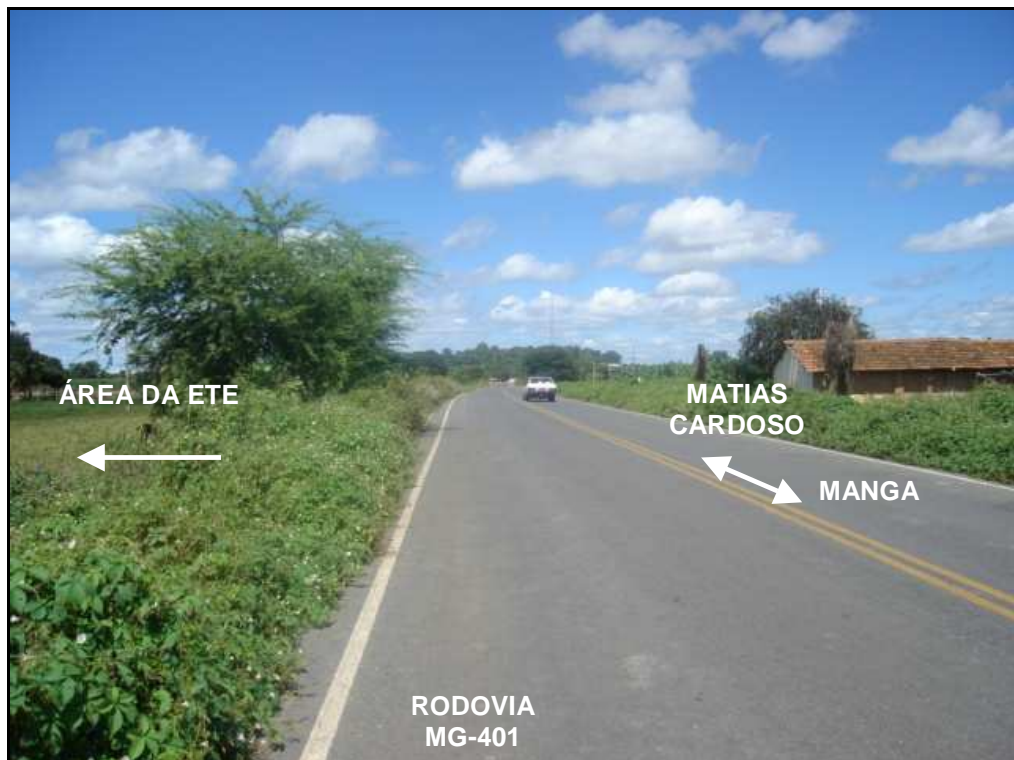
VISTA DA ÁREA DA ETE AO FUNDO DO TERRENO
